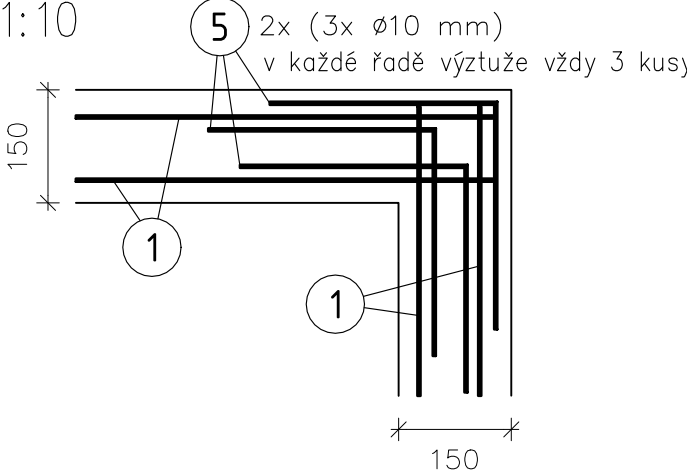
T KRÍŽENÍ VĚNCŮ – 1ks
